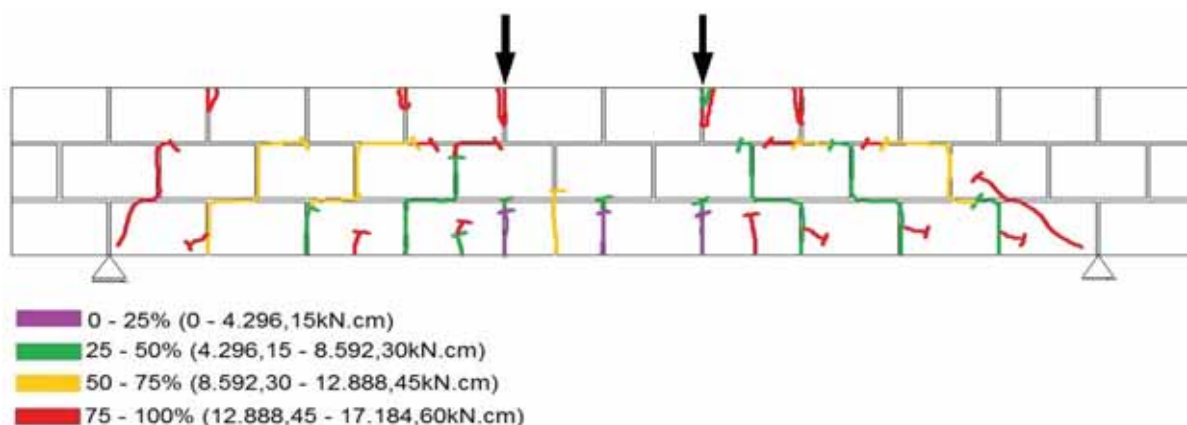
Histórico de fissuração das vigas V3F4, V3F5 e V3F6
